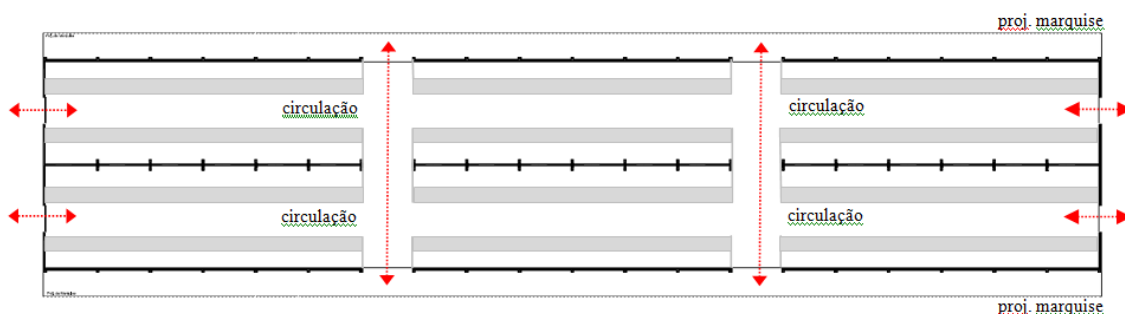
Planta esquemática do Galpão 5, o único do conjunto que possui 80,00m de comprimento.
